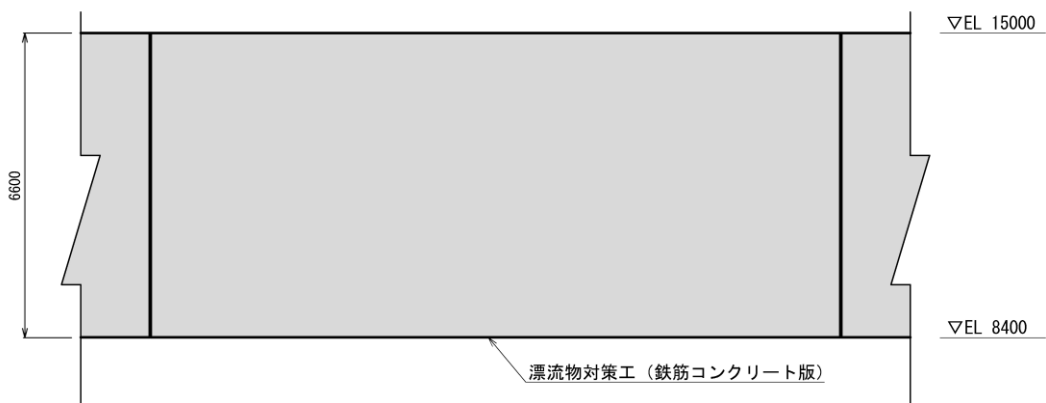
(2) 漂流物対策工（鉄筋コンクリート版）の構造概要図（正面図）
